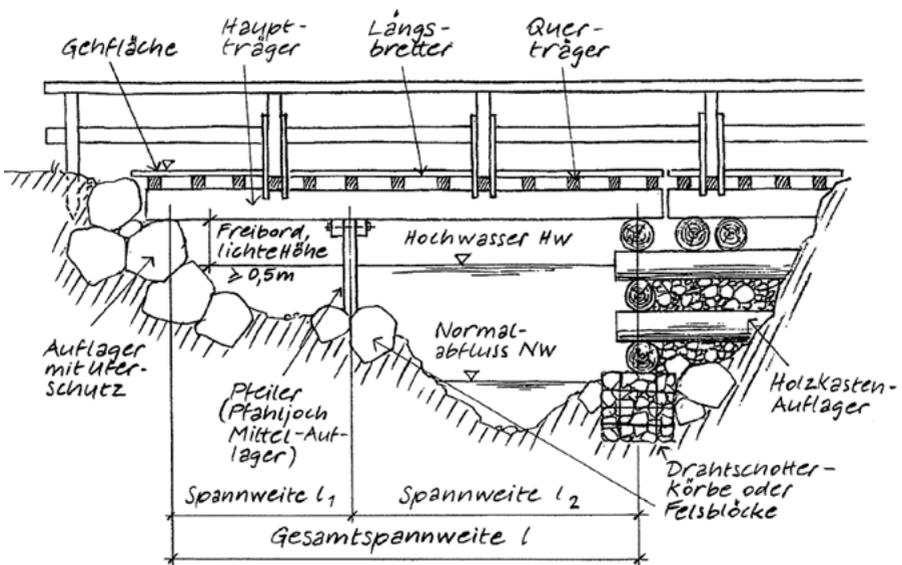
Grundkonstruktion einer Holzbrücke (ASTRA)
